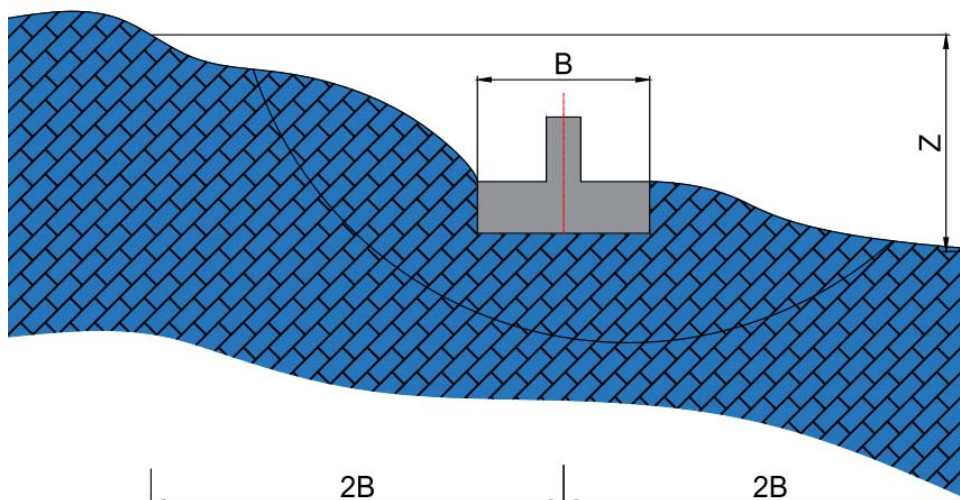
Detalle del fallo global. Fuente: Guía de cimentaciones en obras de carretera
